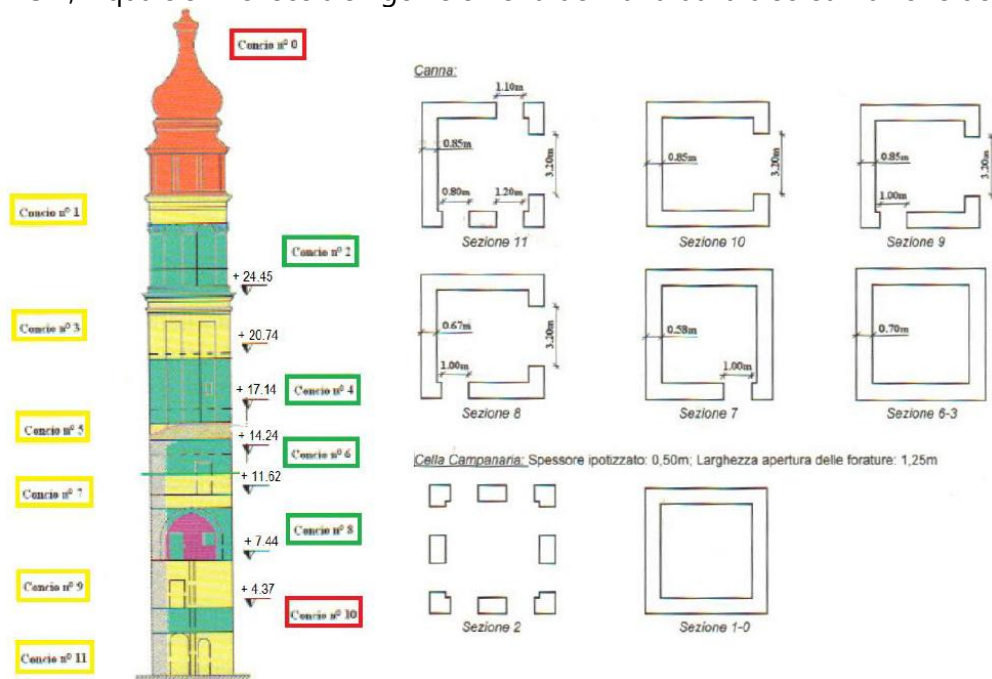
Campanile Sant'Antonin: Sezioni trasversali e suddivisione dei piani nel testo di riferimento
